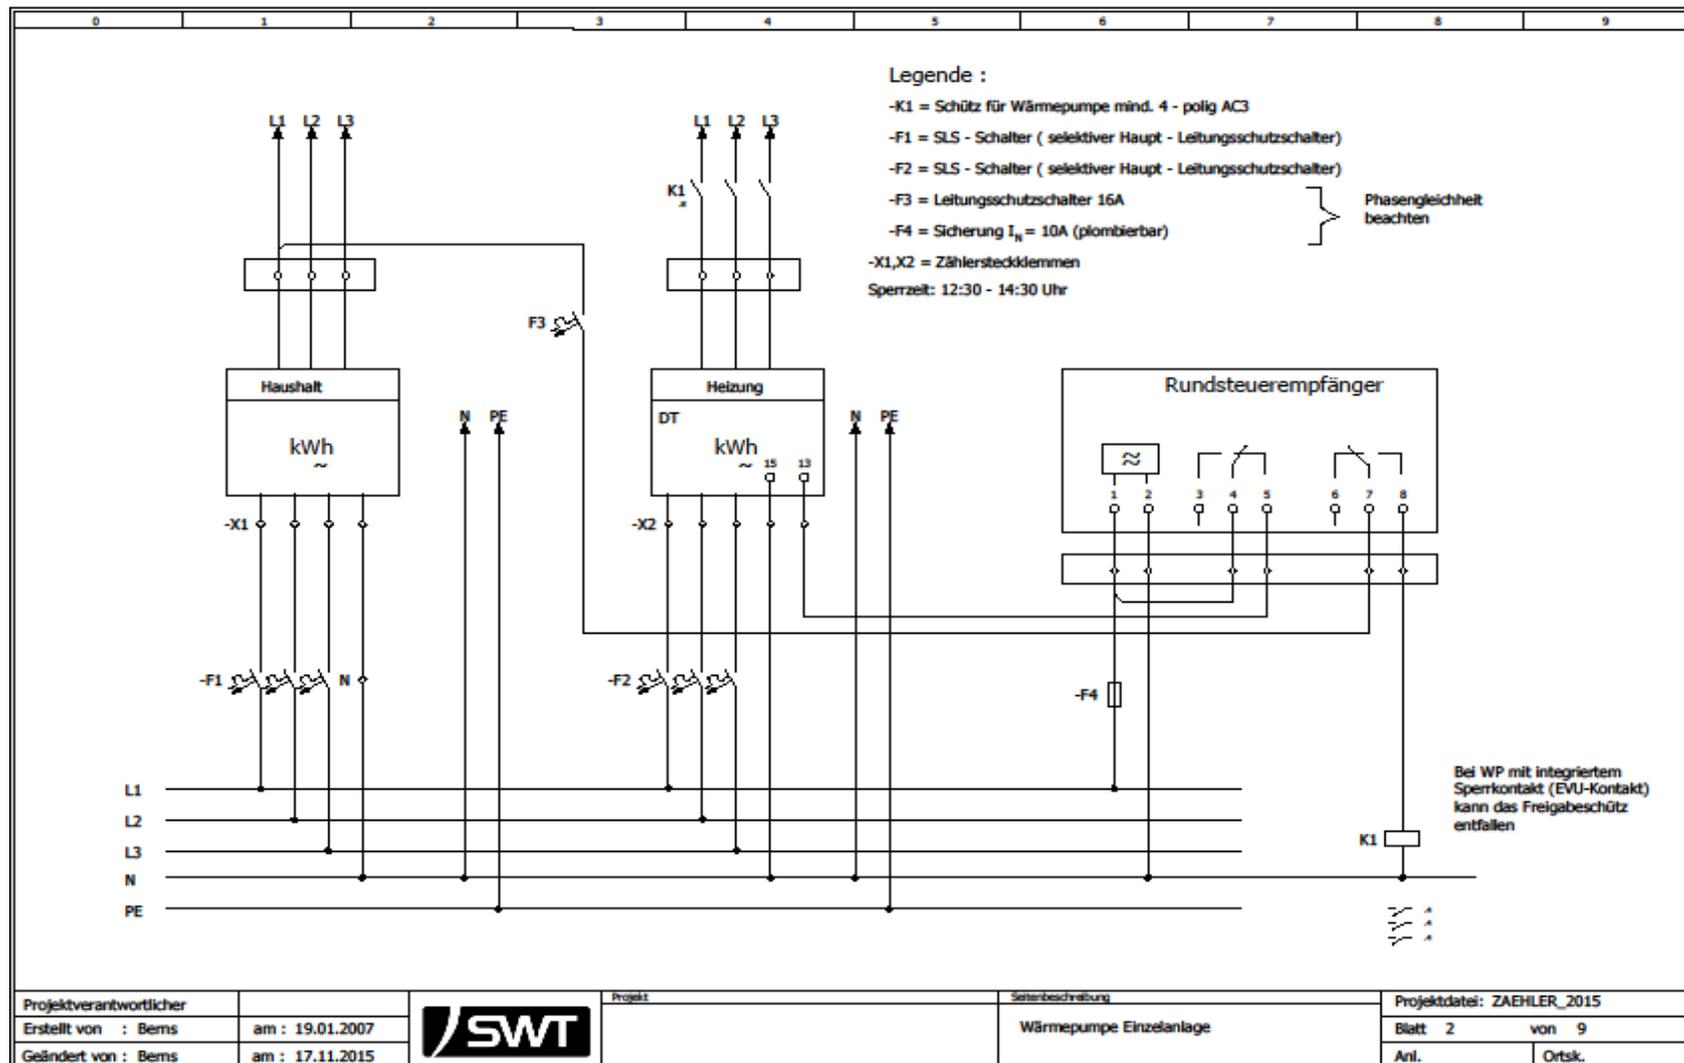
Installationsplan Wärmepumpe Einzelanlage
